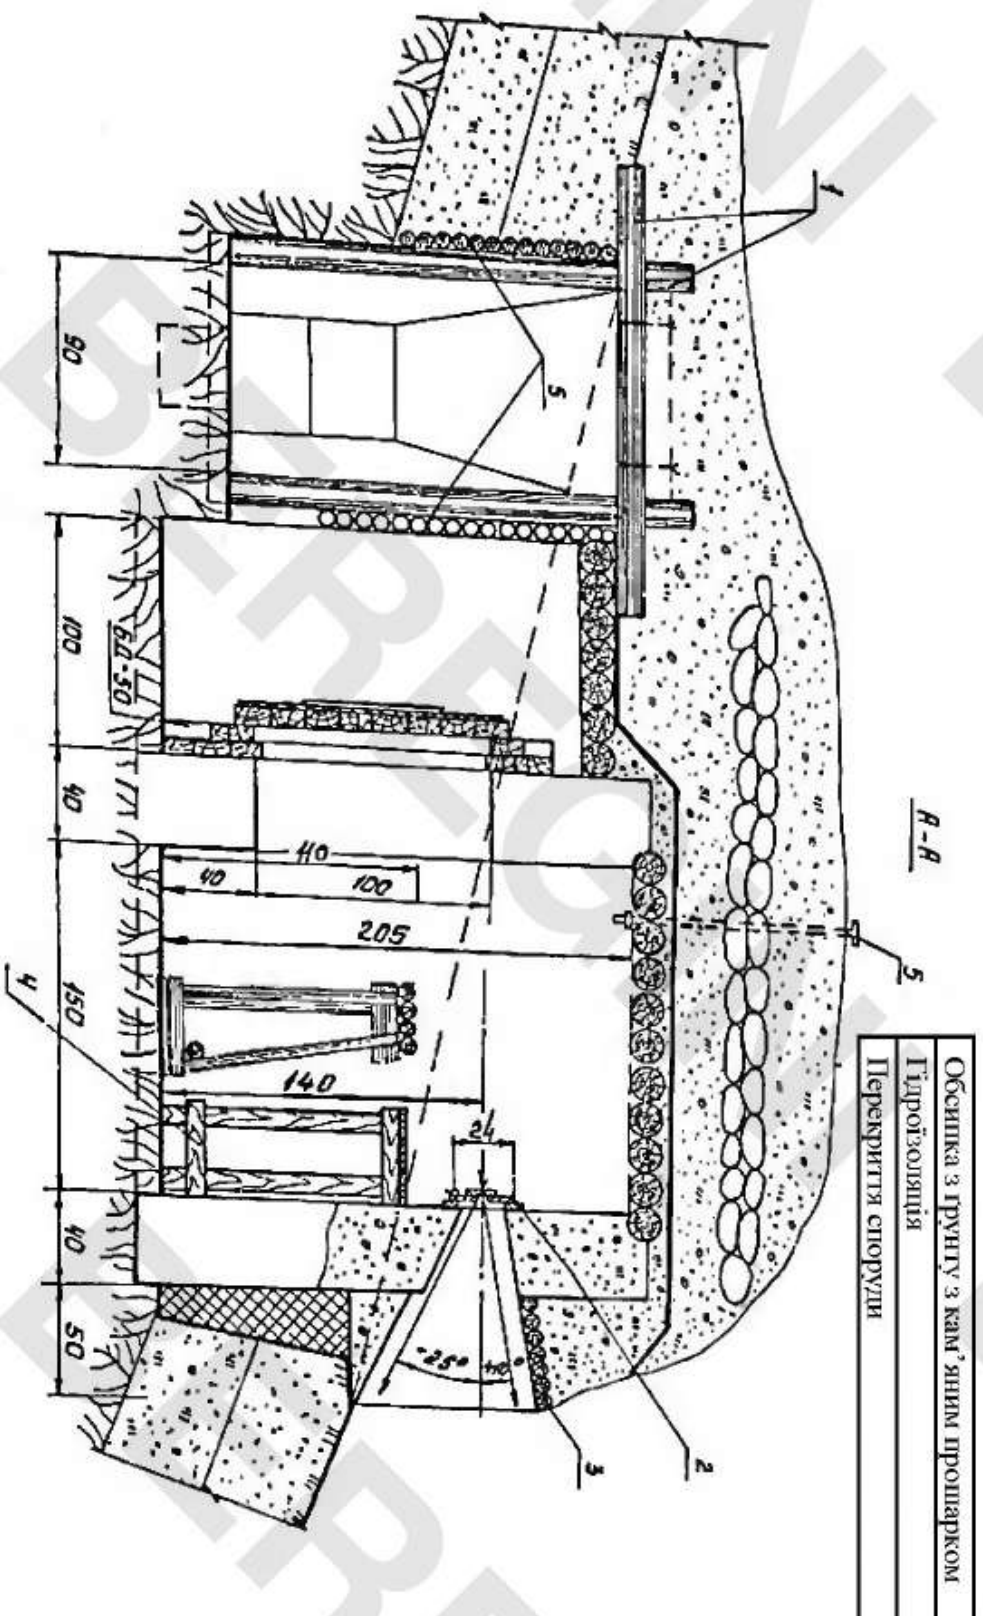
Кулеметна споруда з бетону (розріз):
